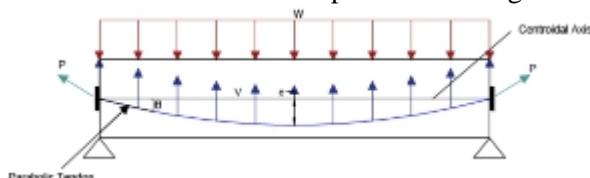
Perbandingan Penulangan Prategang dan Beton Bertulang
